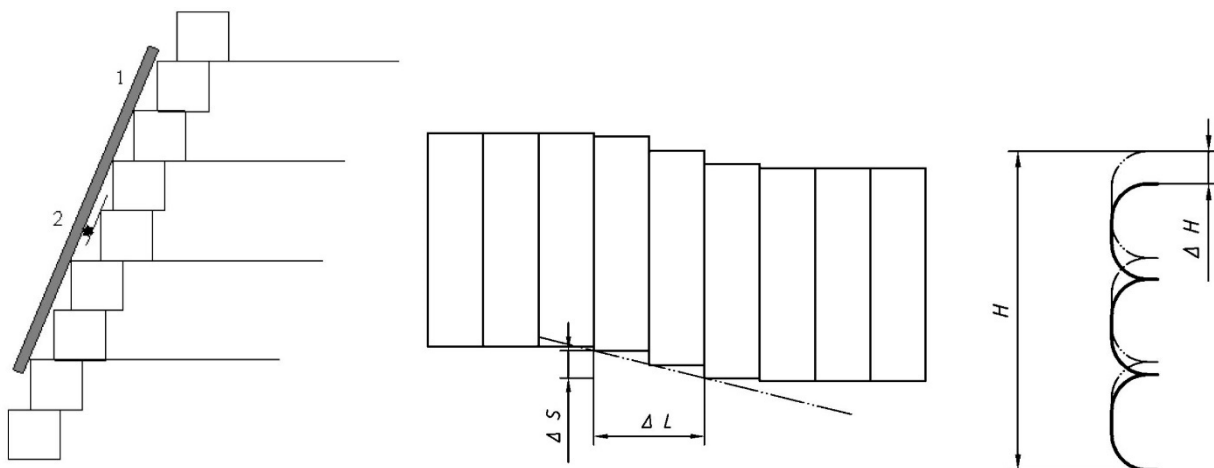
Allineamento, cedimenti in fondazione, compressibilità.
